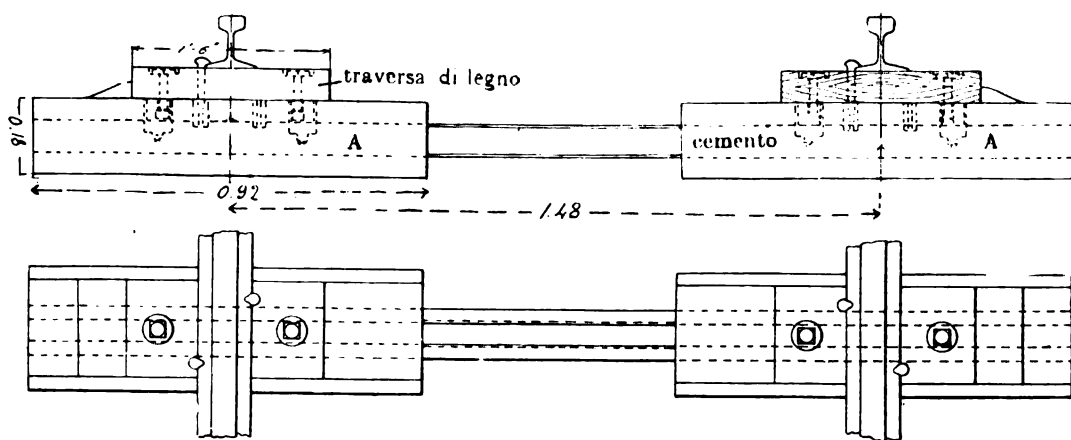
e 16. — Traversa Kimball. (Sezione longitudinale e pianta).
